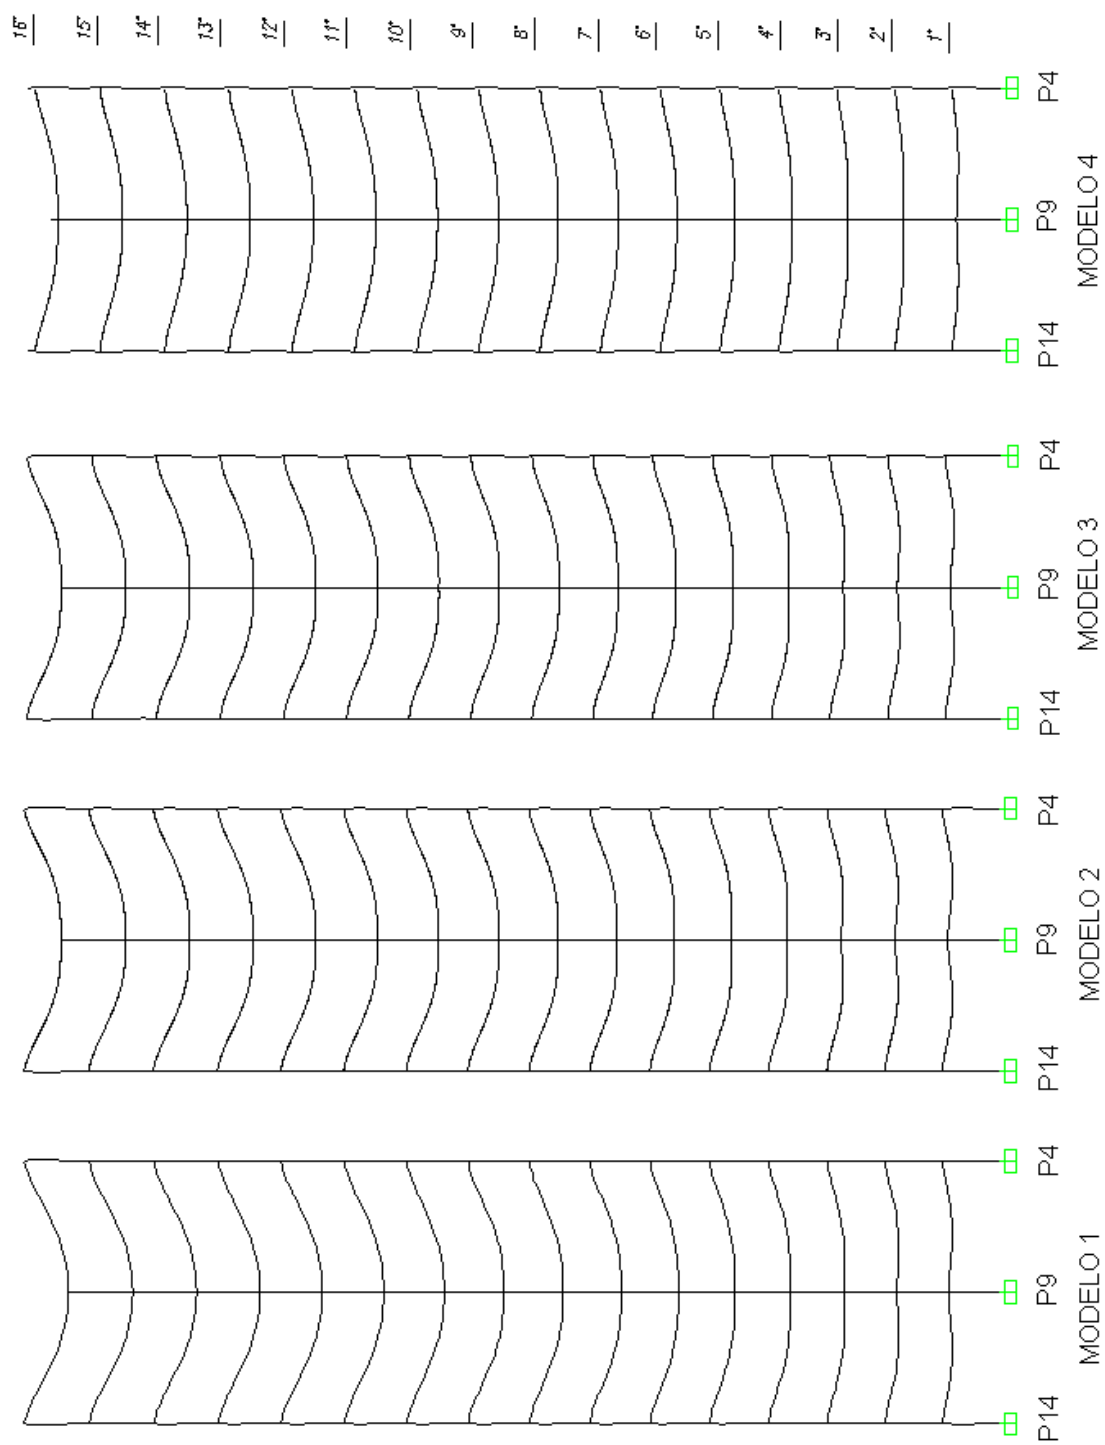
Esboço da Estrutura Deformada das Vigas V13, Para os Modelos 1 a 4
